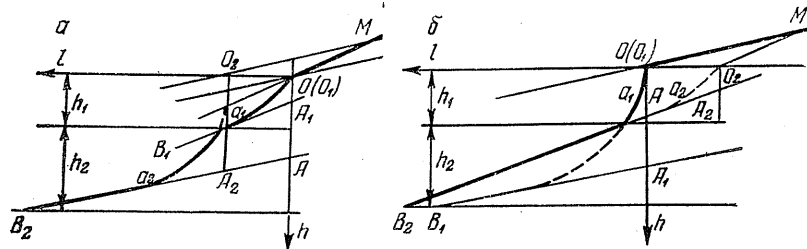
Схемы к расчету устойчивости откоса в слоистой толще по методу Троицкой
